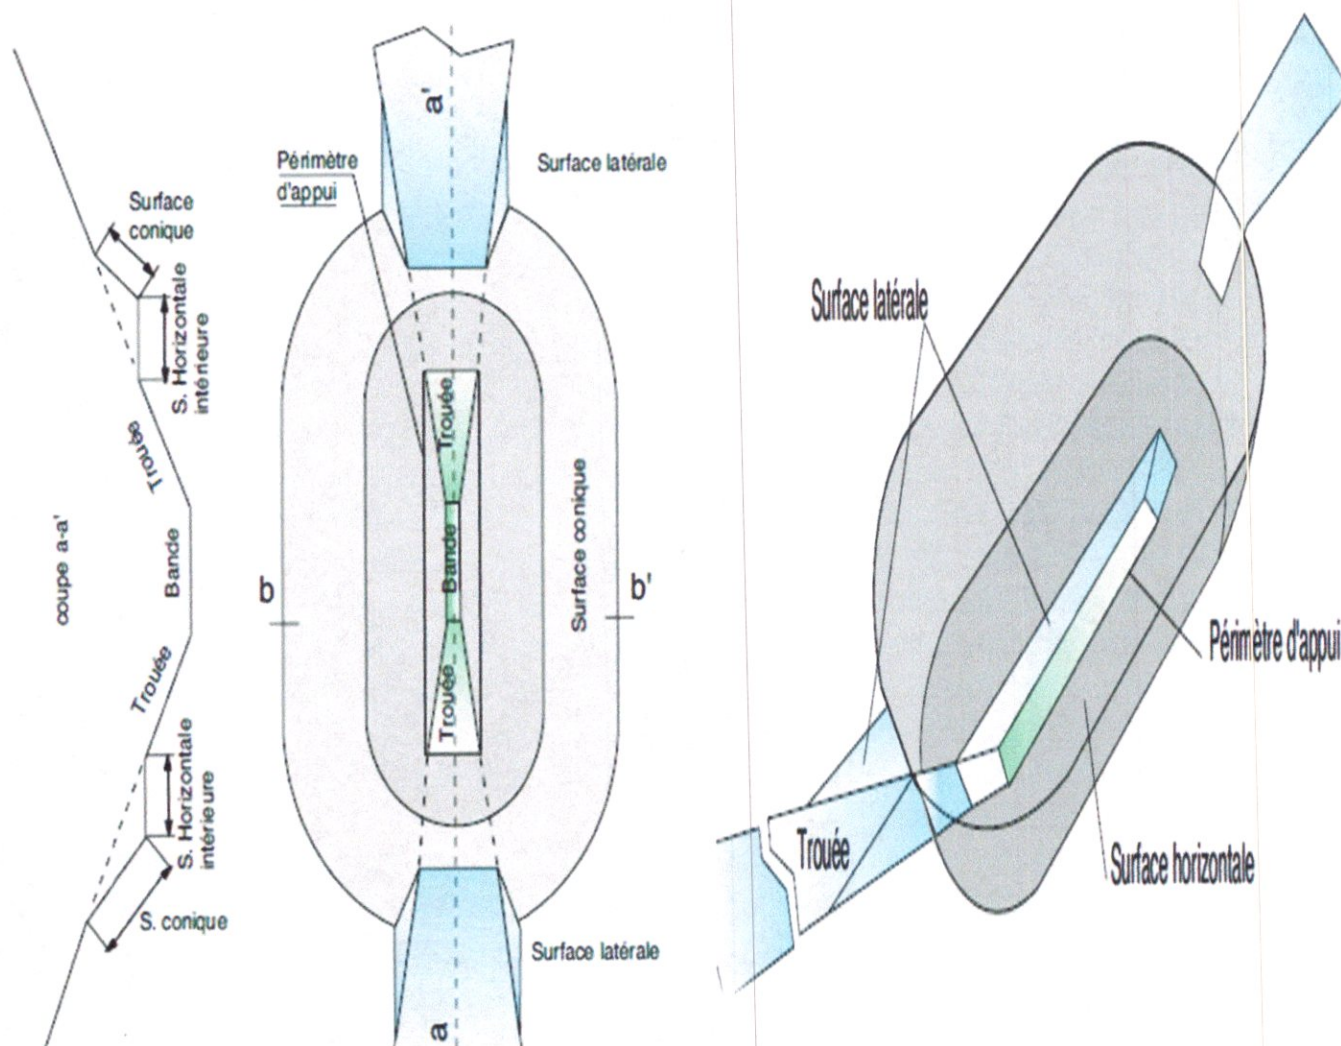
Vue en perspective des surfaces de dégagement [7]
